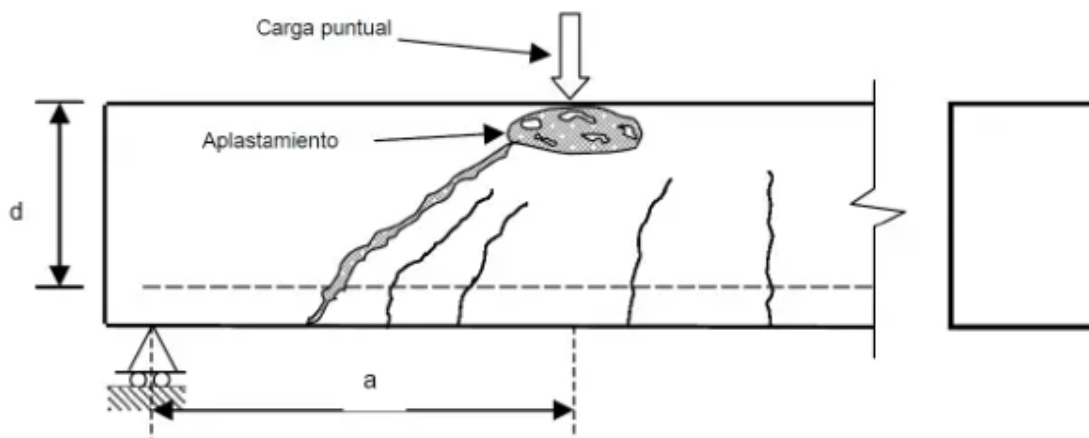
5.* - Zonas de agrietamiento (marcado como fisuración en la figura) de una viga (*Manjarrez & Gomez, 2013*).
